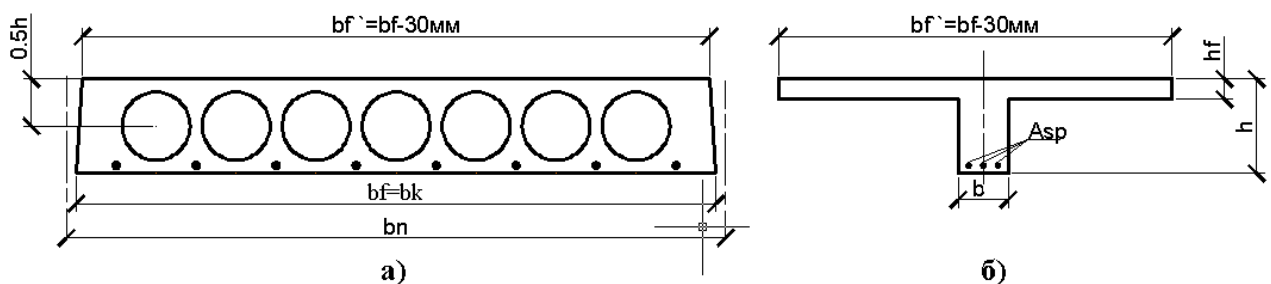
Поперечні перерізи плити: а) фактичний; б) розрахунковий.
